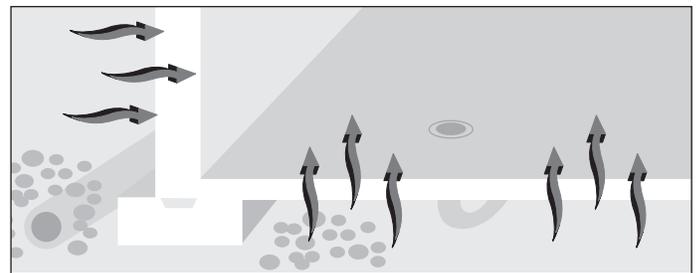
Diffusion de la vapeur d'eau à travers les murs ou la dalle de plancher
